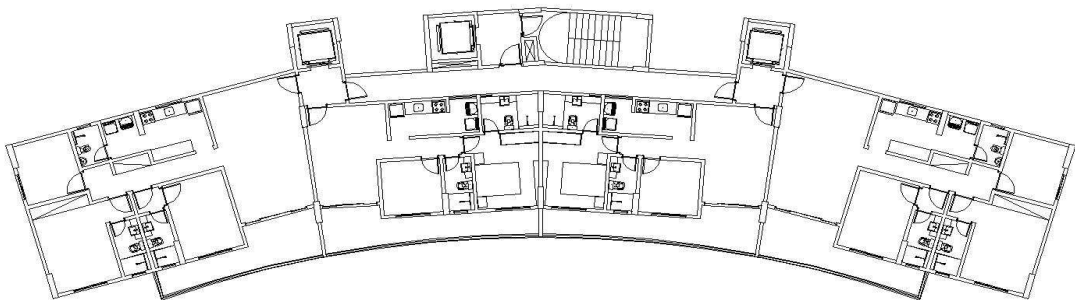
Planta do Pavimento Tipo do Estudo 02 do Escritório 01
